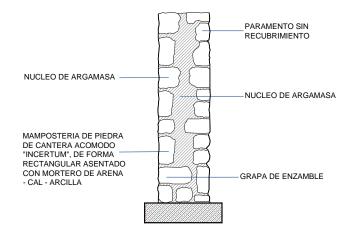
Detalle del muro de mampostería de cantera.
